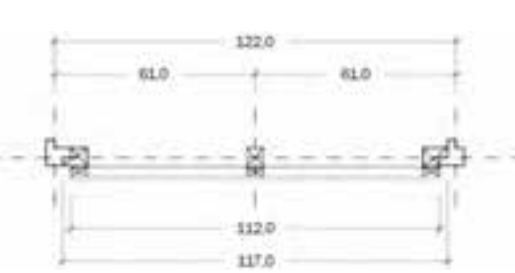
Esquema ilustrativo de la definición de las medidas de ancho de los paneles de muro.
